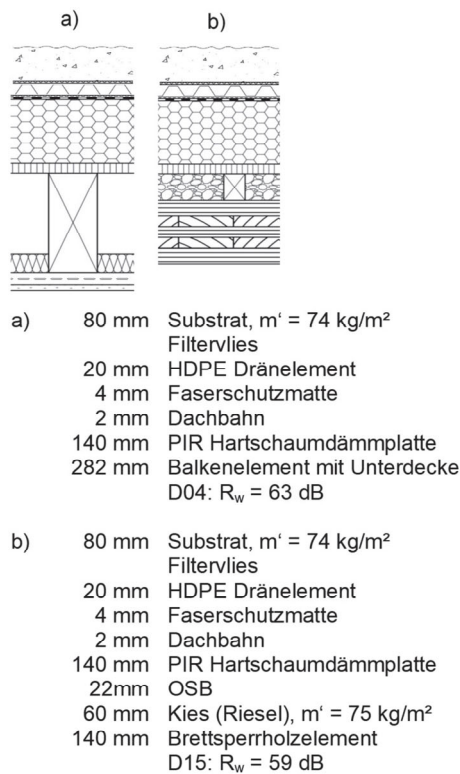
Gründachaufbau mit HDPE-Drainageelementen auf dem Balkenelement und dem Massivholzelement mit Beschwerung
